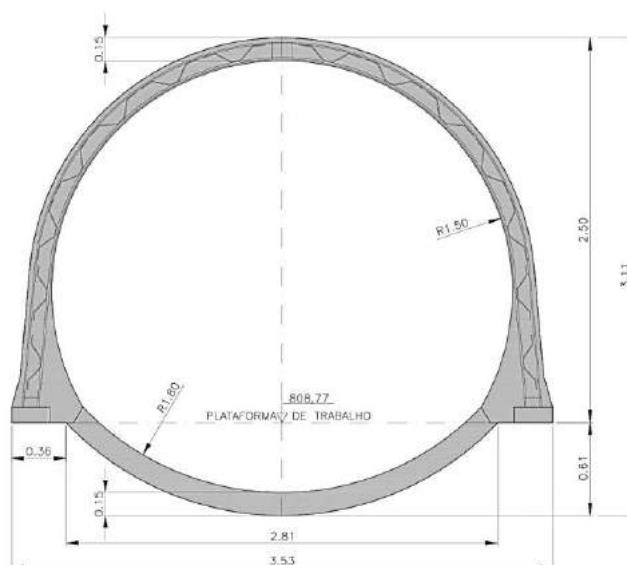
Geometria de escavação e revestimento primário do túnel piloto. Fonte: Projeto Executivo.
